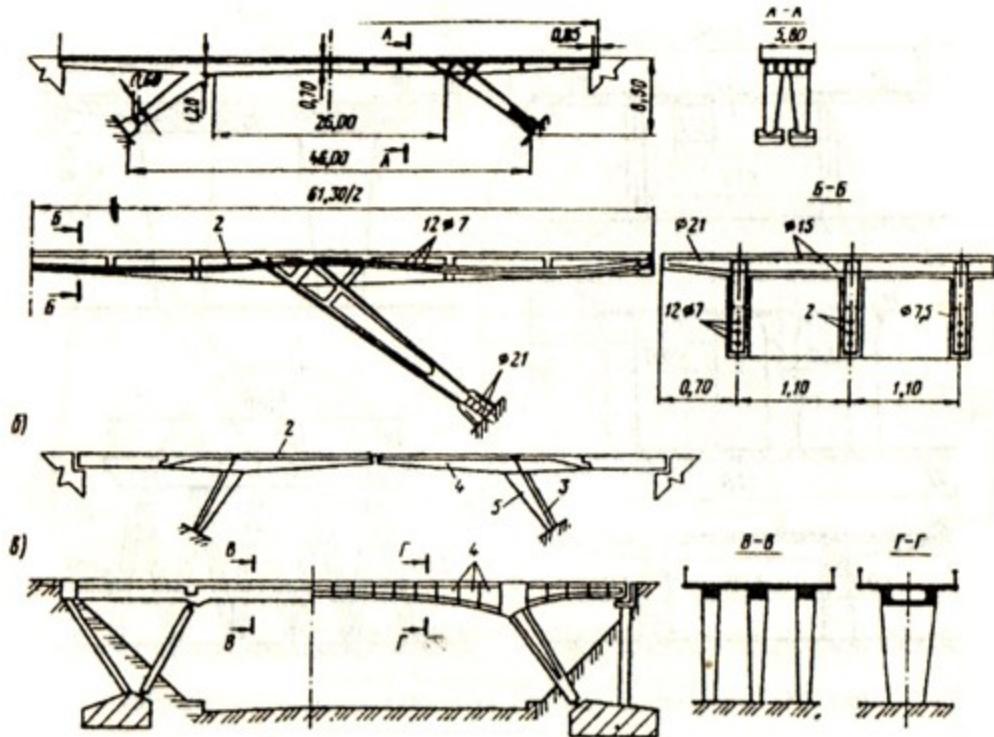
Конструкция железобетонных путепроводов рамной и комбинированной систем:
